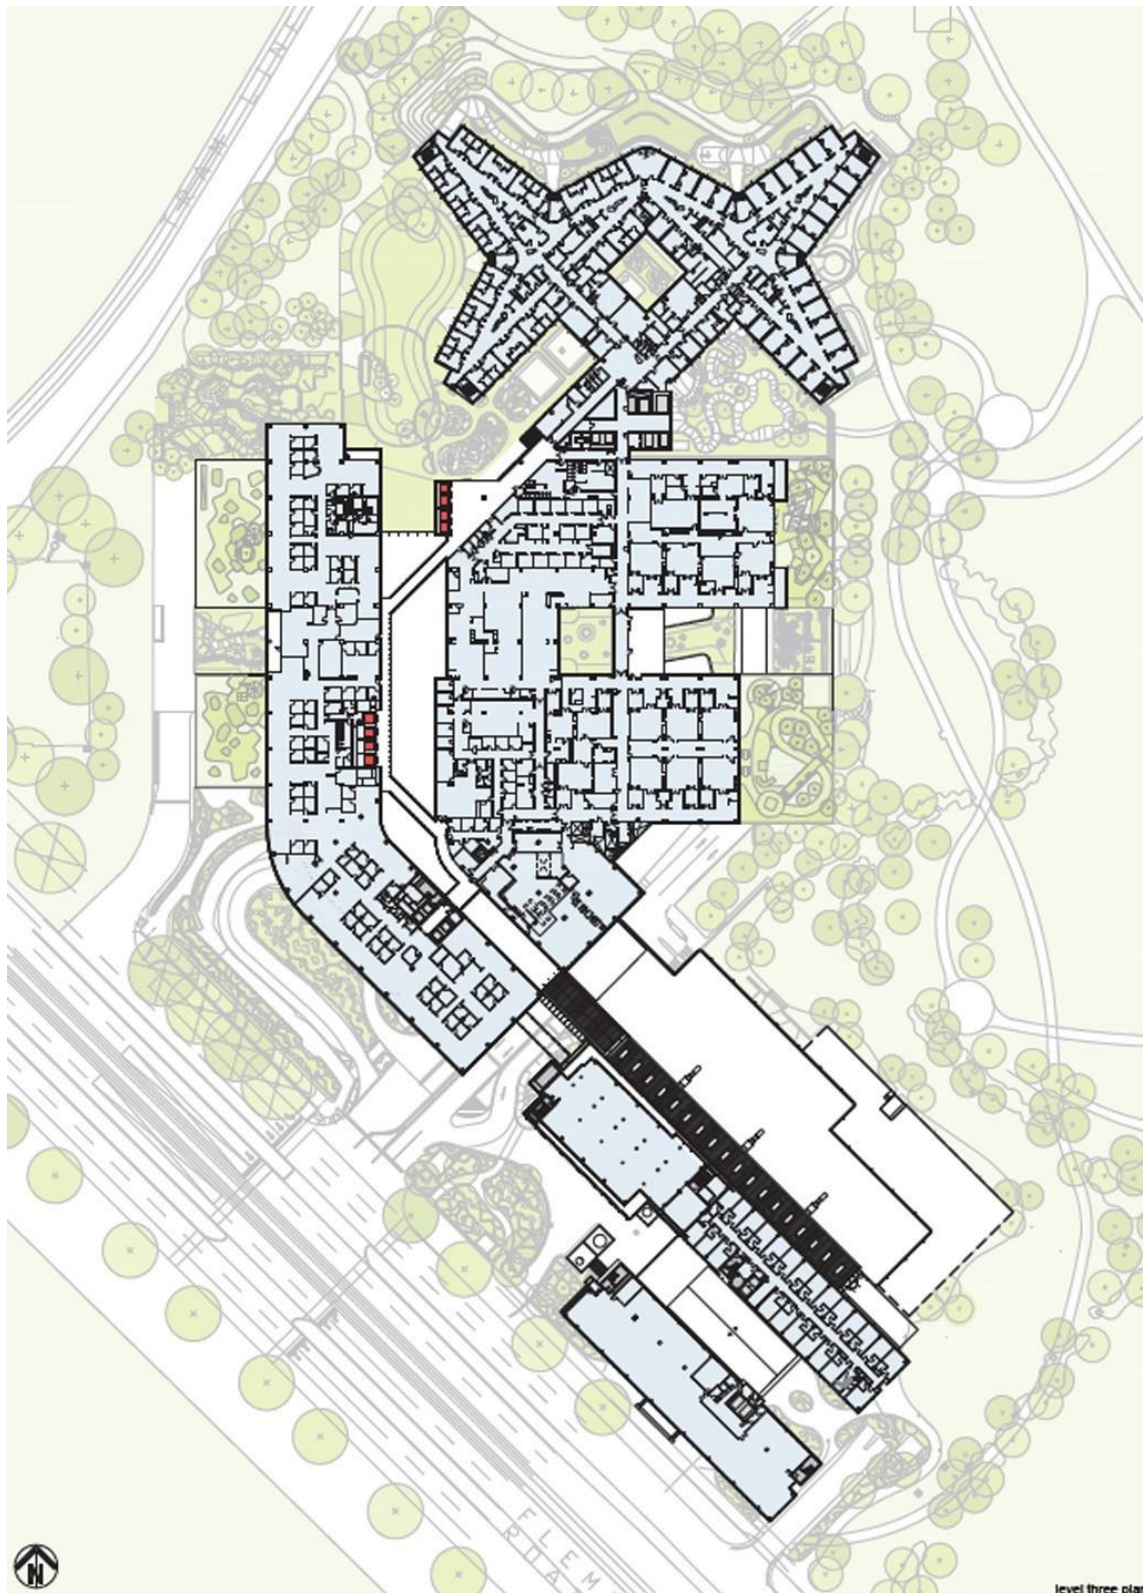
Planta baixa do The Royal Children's Hospital- Fonte:
